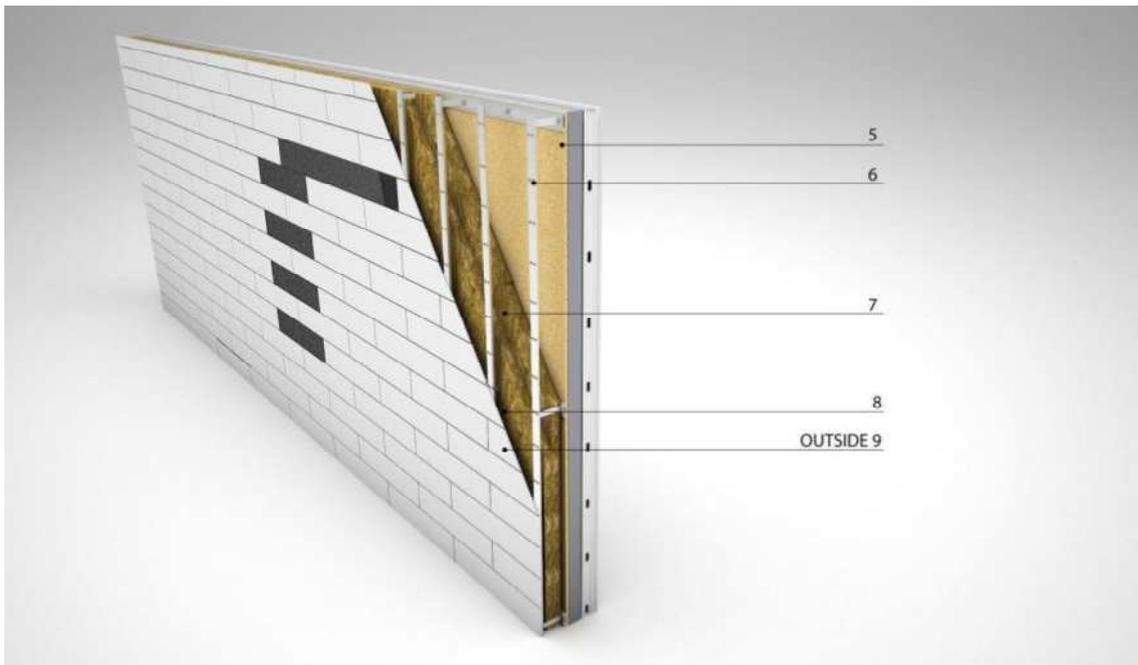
Detalle de las capas exteriores de la fachada del prototipo; Fuente: eBRICKhouse project manual
